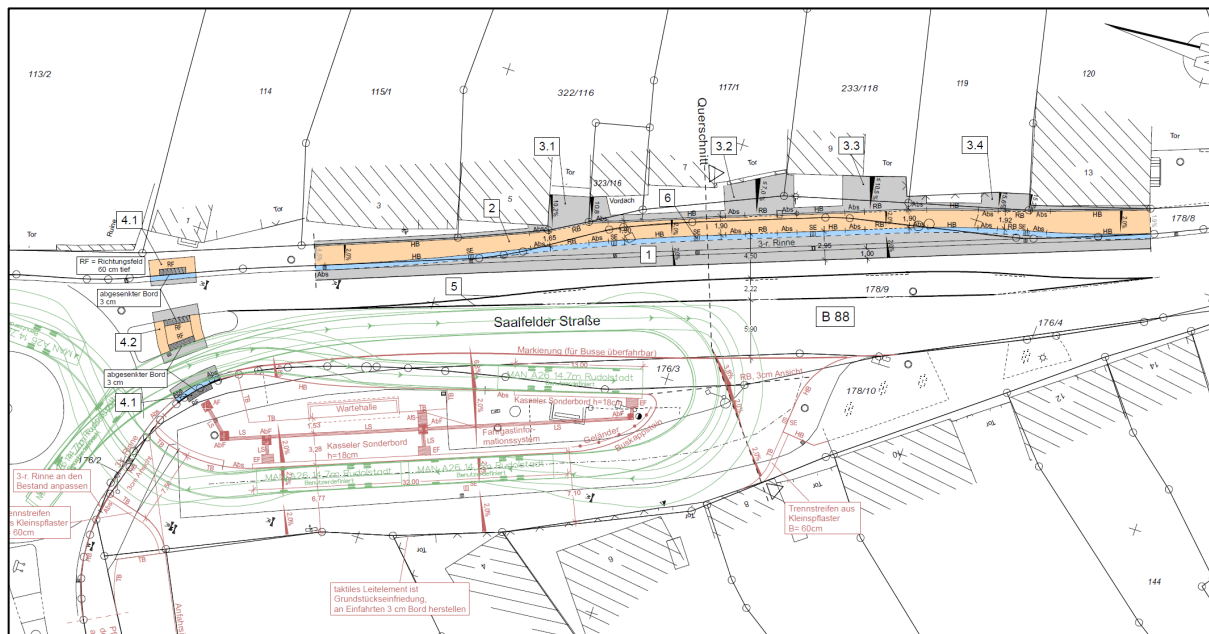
Lageplan Feststellungsentwurf (Emch + Berger GmbH, Stand: 11/2017, o. M.)
